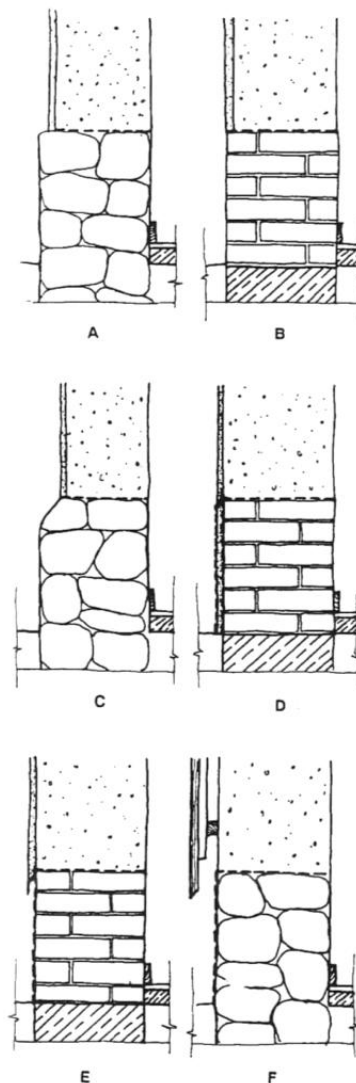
Fundação em Betão Ciclópico e em Betão Armado
